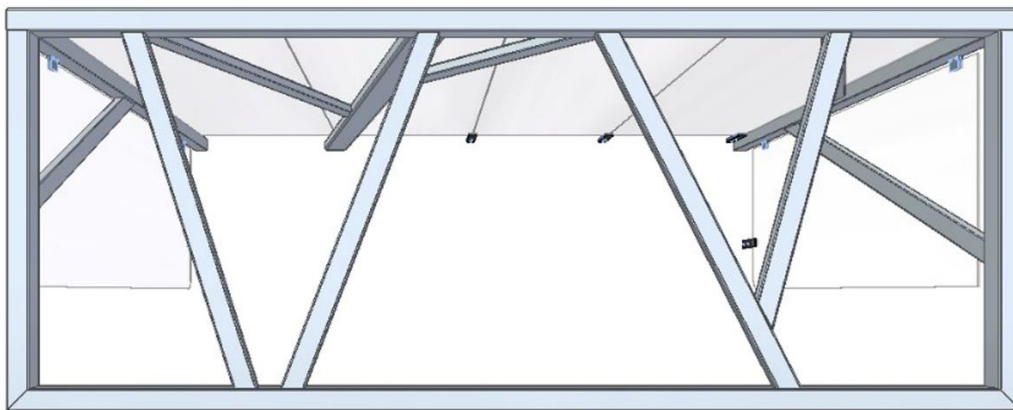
Parte superior da estrutura do abrigo, suporte, visto de topo
